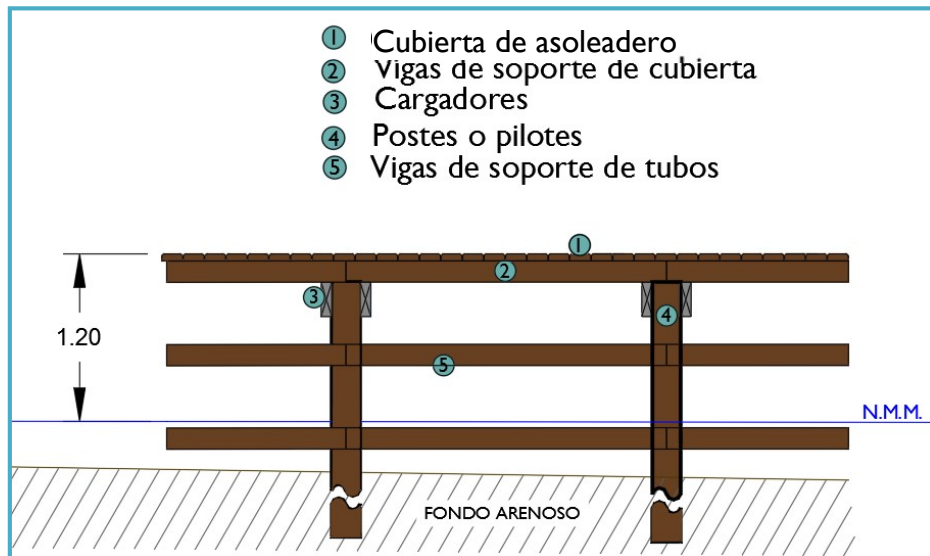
VISTA LATERAL DE LA SECCIÓN DE ASOLEADERO REFORZADO
